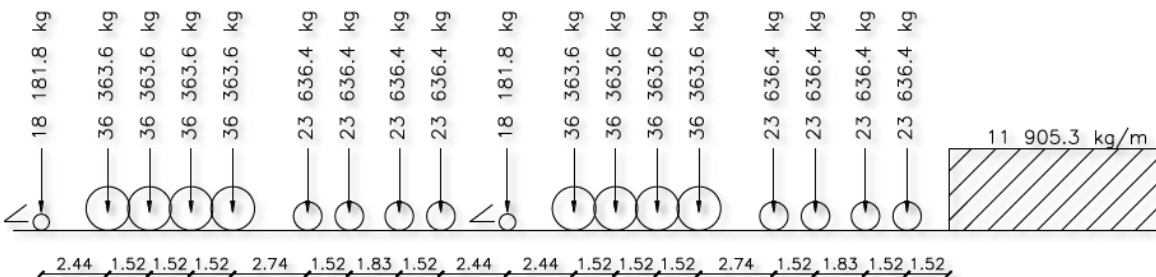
Locomotora de diseño de puentes ferroviarios Cooper E-80 [2.7].
